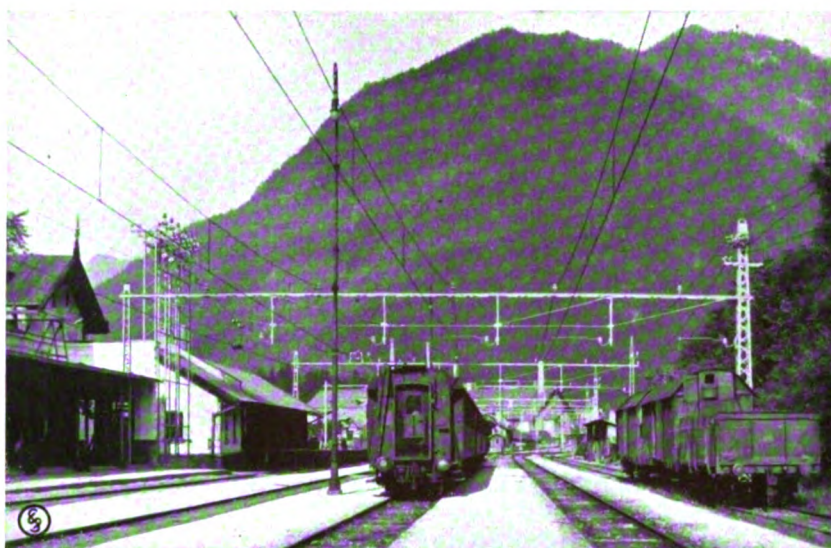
Fahrleitungsanlage auf Bahnhof Aussee.
